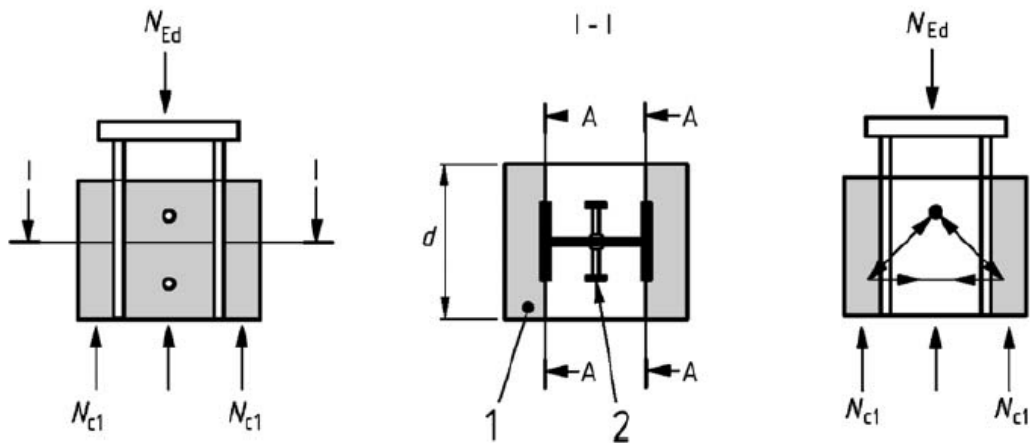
Додаткові сили тертя у сталезалізобетонних колонах із стал-болтами на стінках перерізу
